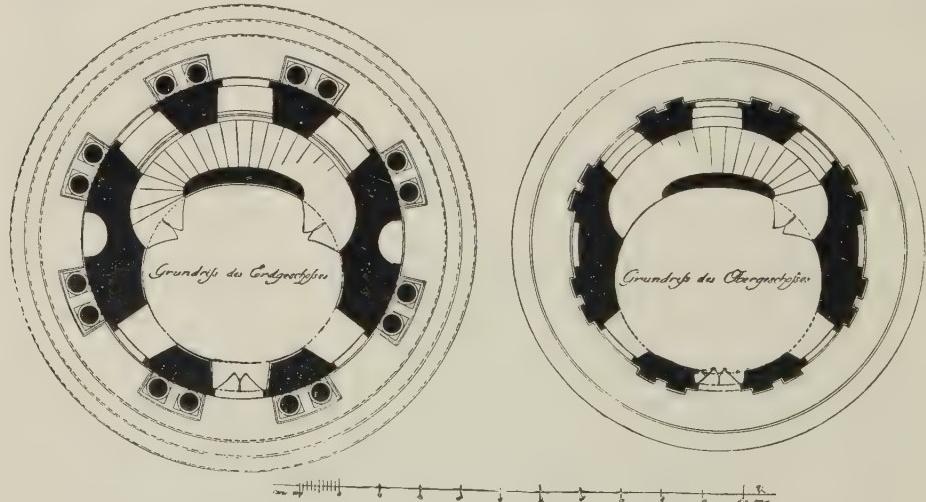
Rundtempel im Pillnitzer Schloßgarten Grundrisse
